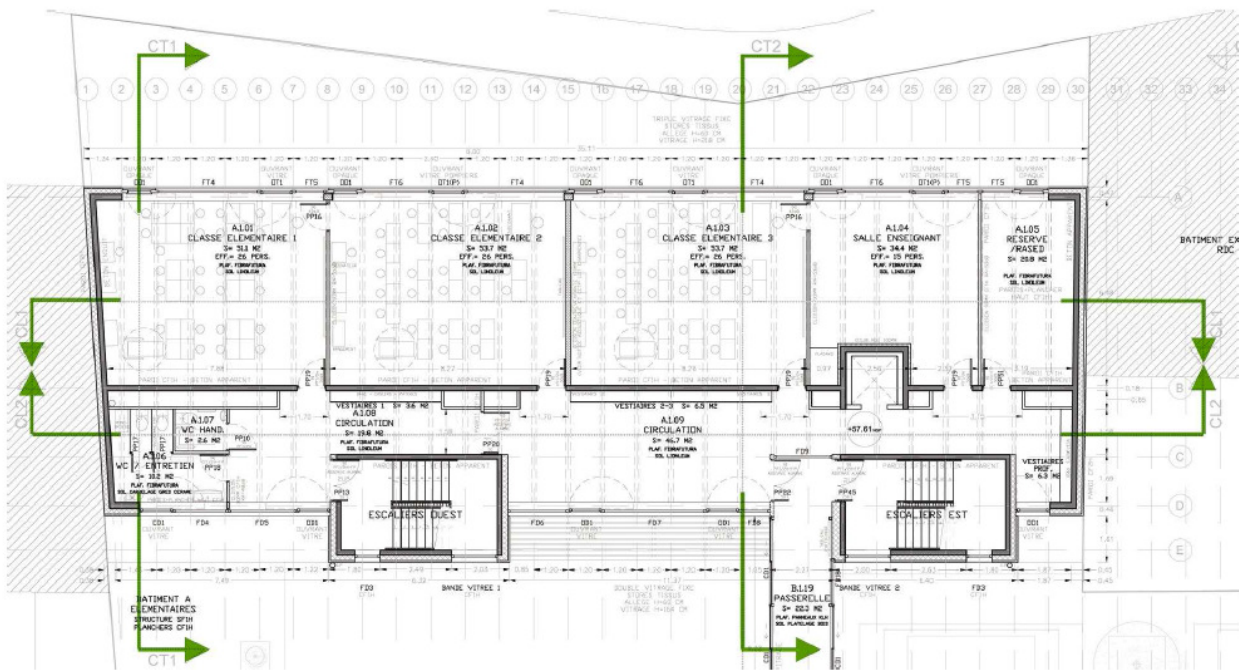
PLAN DU 1ER ETAGE DU BATIMENT A (CLASSE SELEMENTAIRES)
